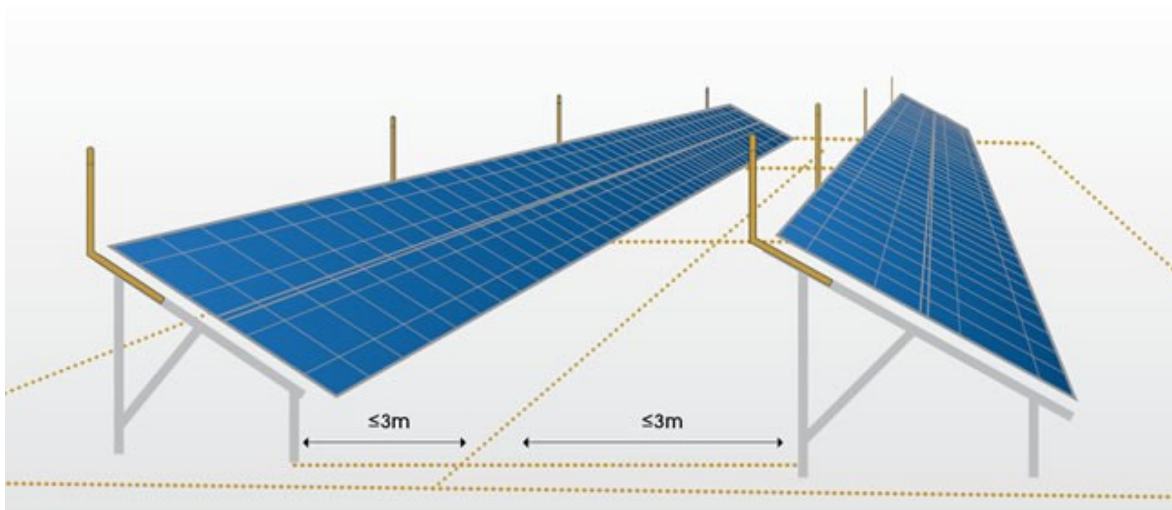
Schema di un impianto fotovoltaico protetto da parafulmine.
